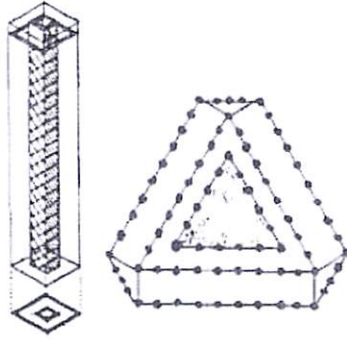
Jarak kolom eksterior yang rapat ditambah dengan dua dinding geser (Shear Wall).
